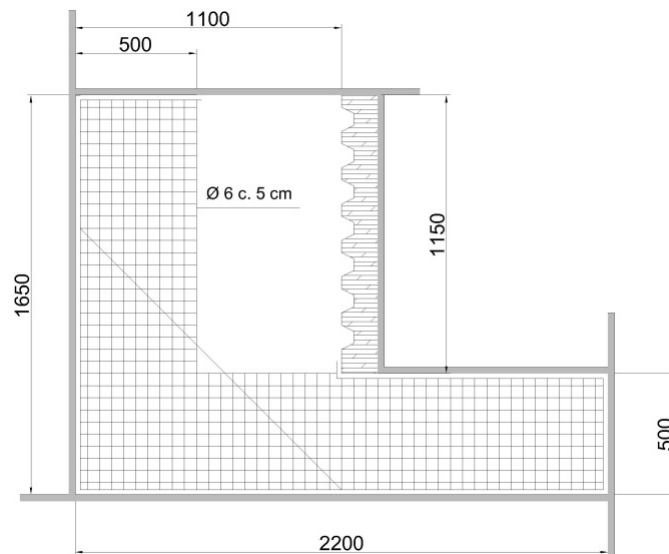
Disposición de la malla electrosoldada para evitar la fisuración superficial durante la manipulación de las piezas de hormigón para la junta de siete llaves (dimensiones en mm)
